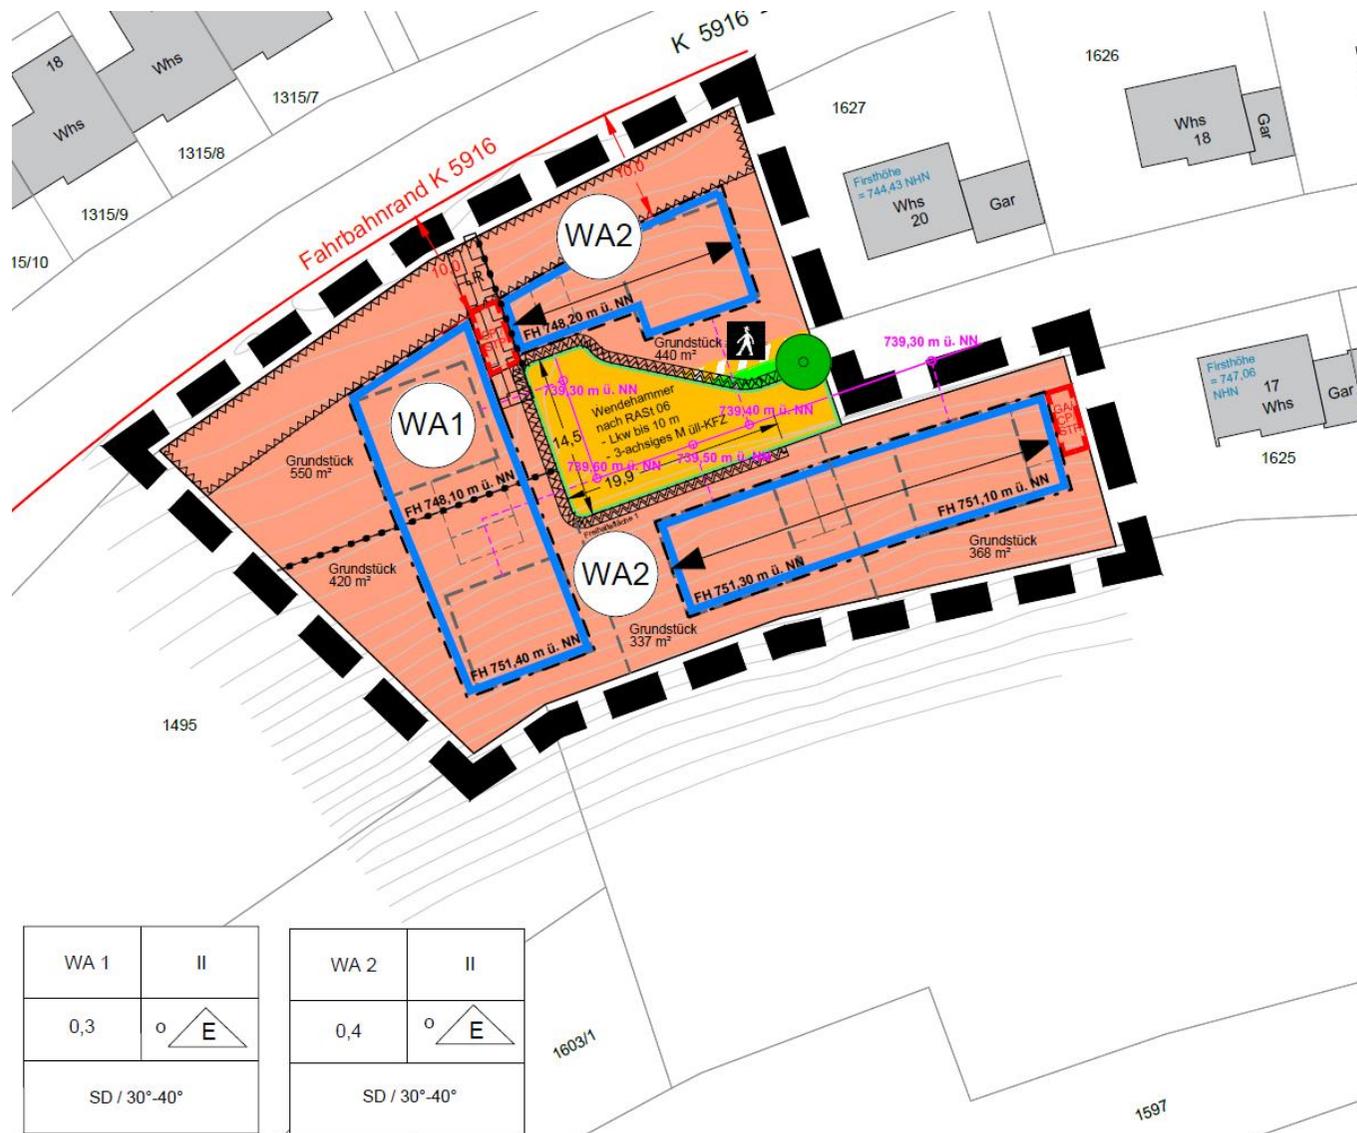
Entwurf des Bebauungsplans „Am Bogen“ vom 22.11.2021 (Quelle: Planstatt Senner)
